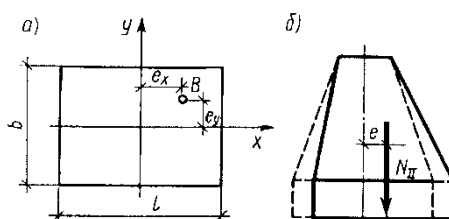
внецентренное загрузеение фундамента относительно двух глвных осей инерции:
